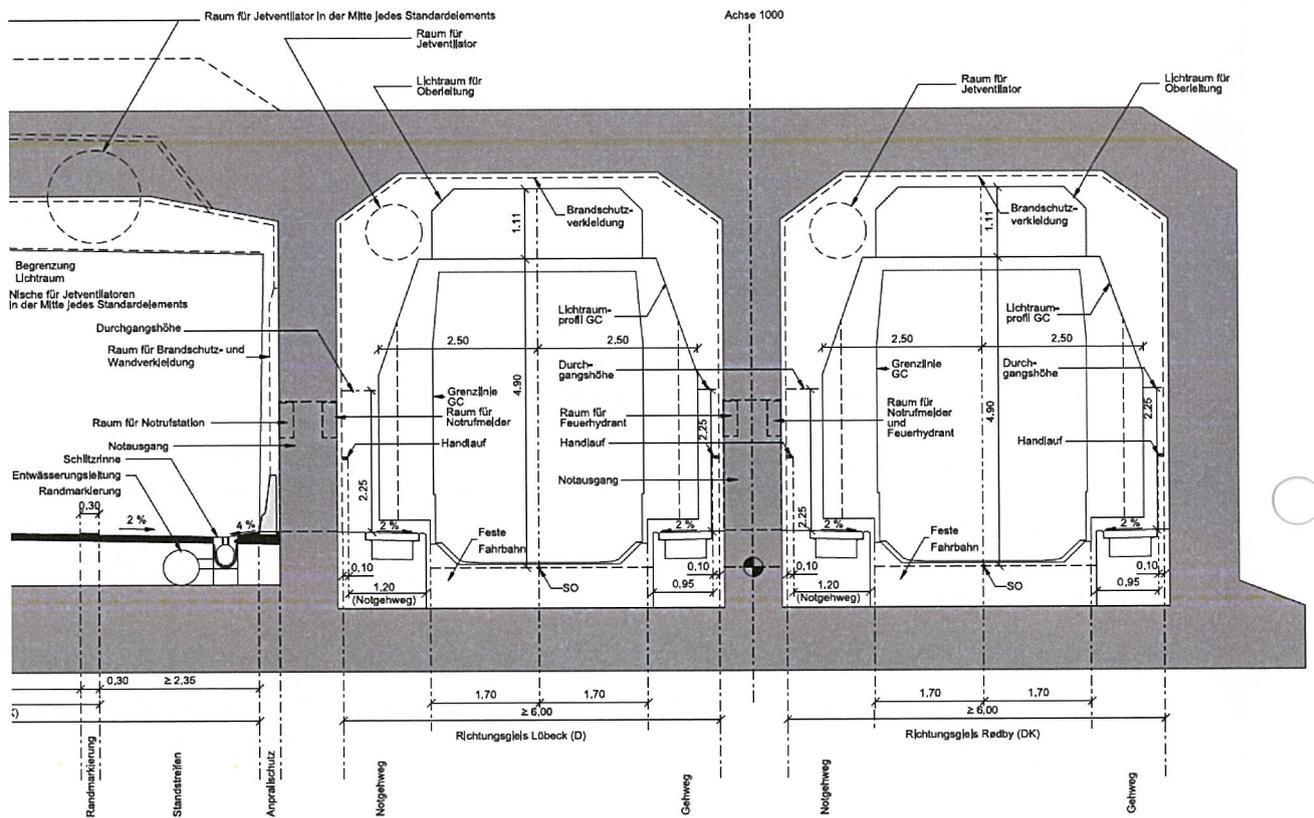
Tunnelquerschnitt Bahnbereich
